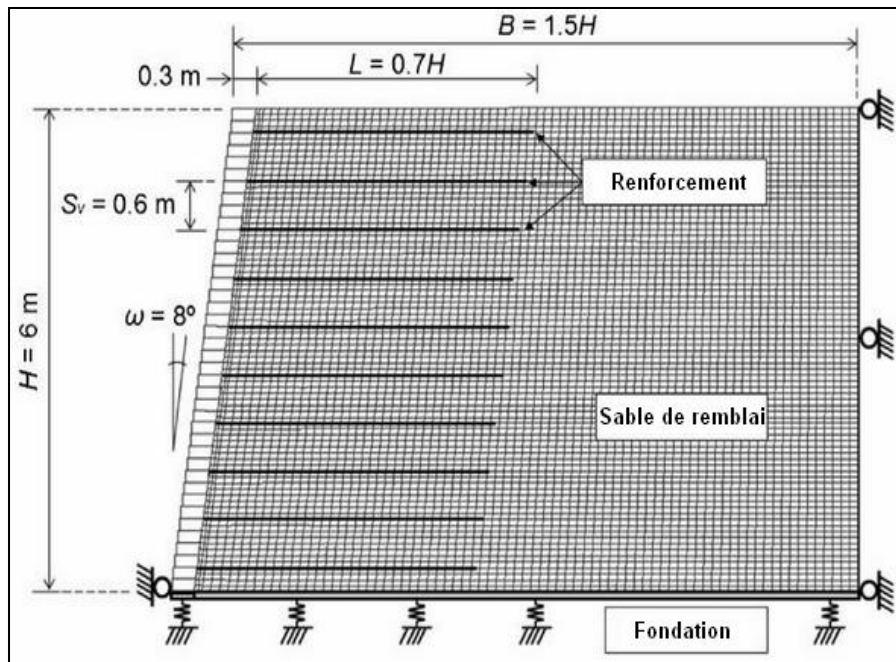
Modèle numérique d'un ouvrage de soutènement avec un sol de fondation compressible
